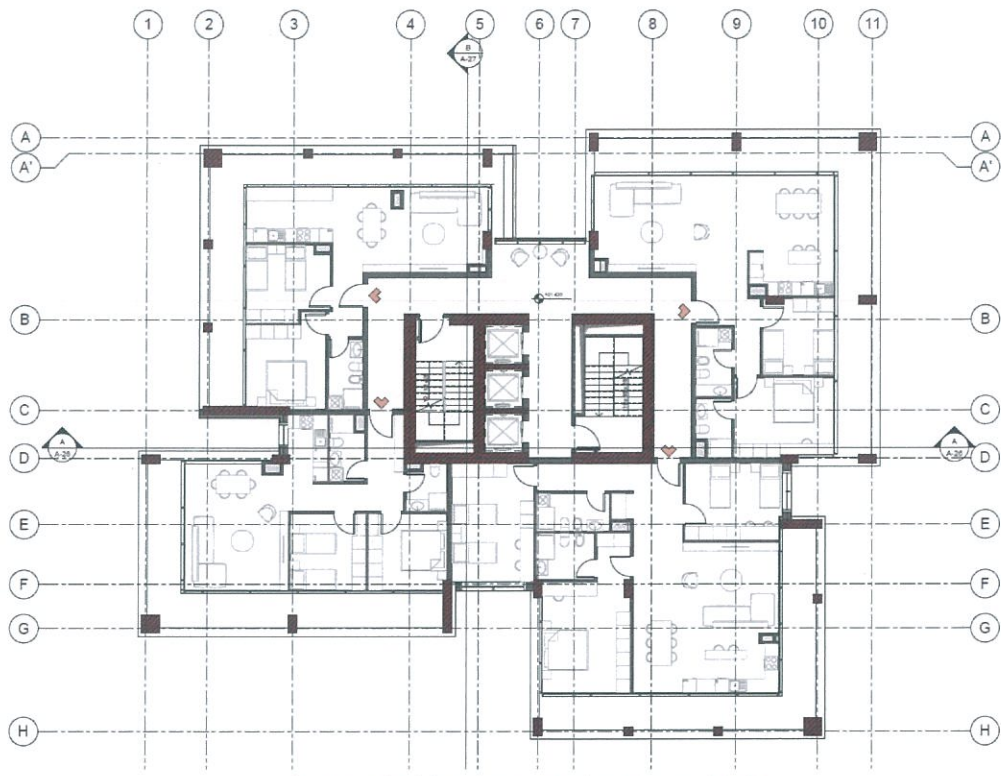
Plani i Katit +5 - Banim, Kuota +21.42
